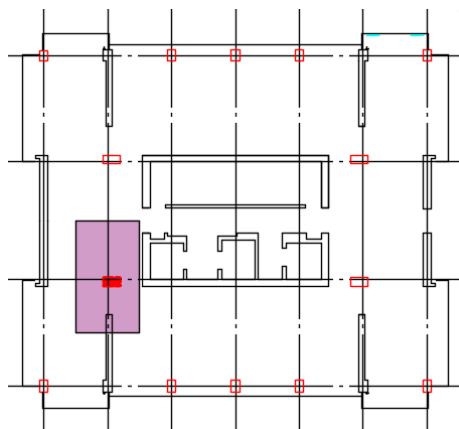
Vue en plan de la surface chargée qui revient aux poteaux C1.
